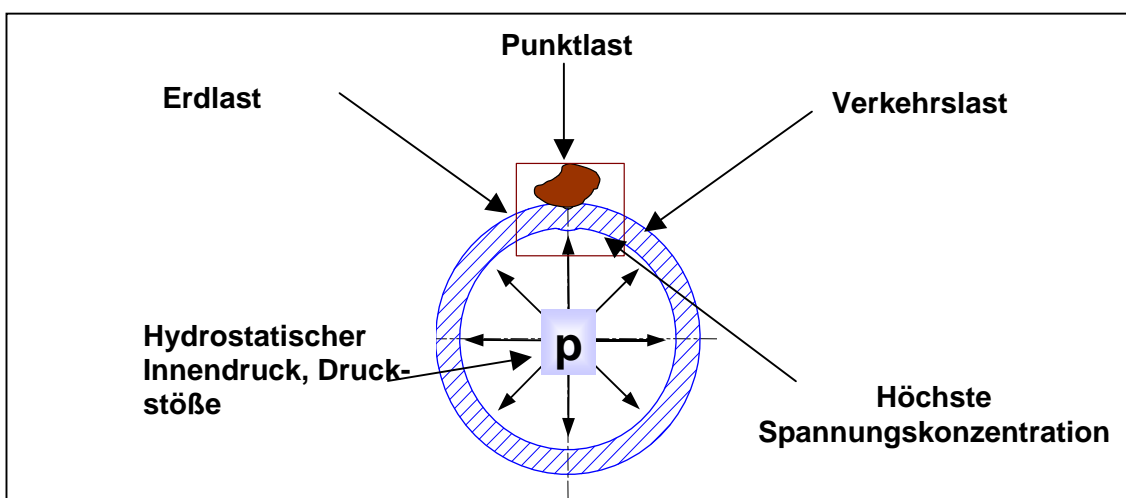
Darstellung einer am Rohr wirkenden Punktlast
